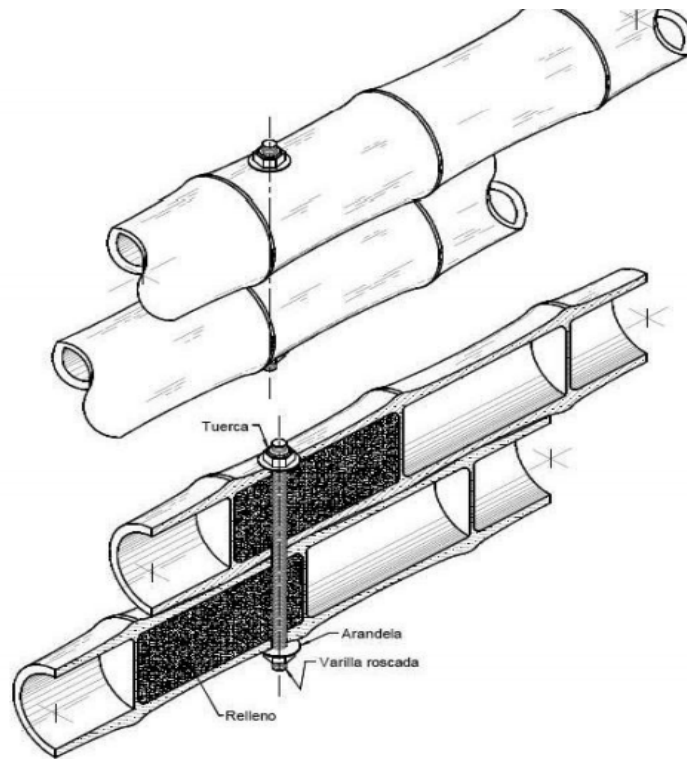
Figura G.12.8-2 - Detalle conectores secciones compuestas
